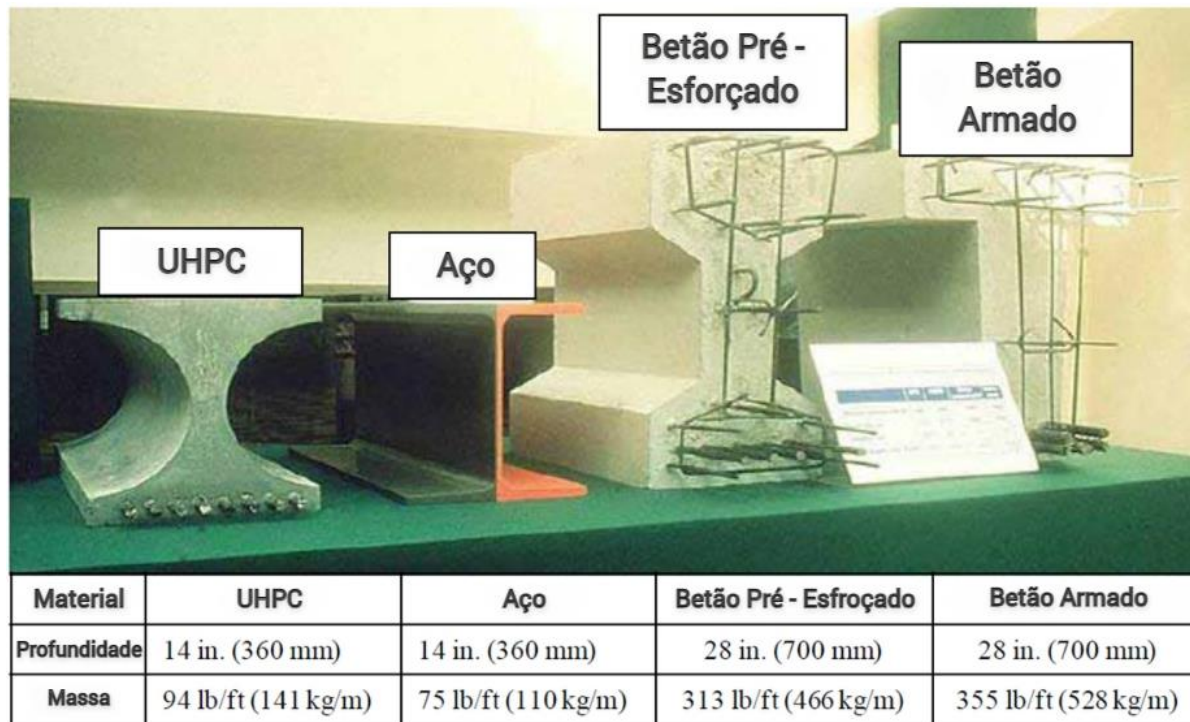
Comparação de características físicas de um elemento viga de aço, betão UHPC, pré-esforçado e armado (Voort *et al.*, 2008).
